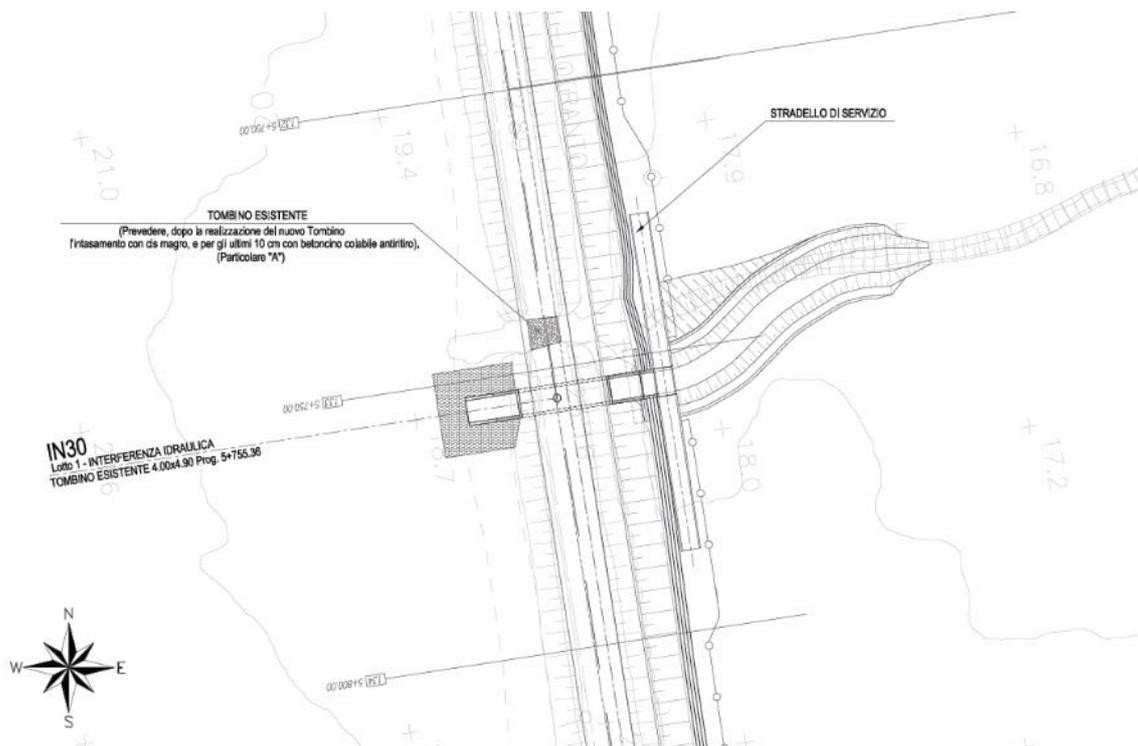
Adeguamento idraulico Fosso Capoposta – Vista Planimetrica
